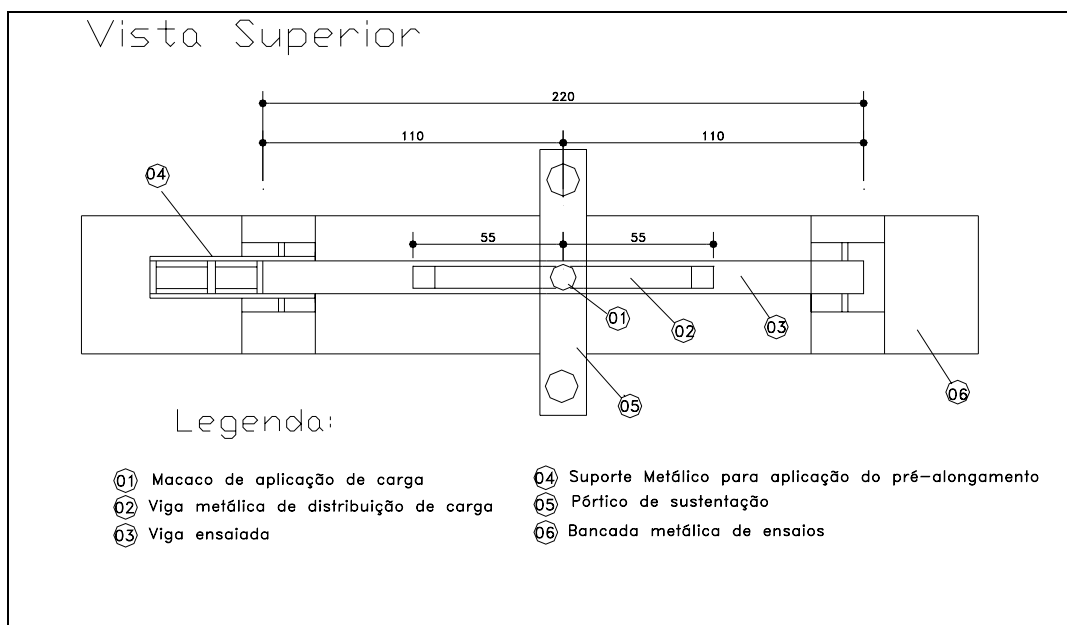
SISTEMA PARA APLICAÇÃO DAS CARGAS
